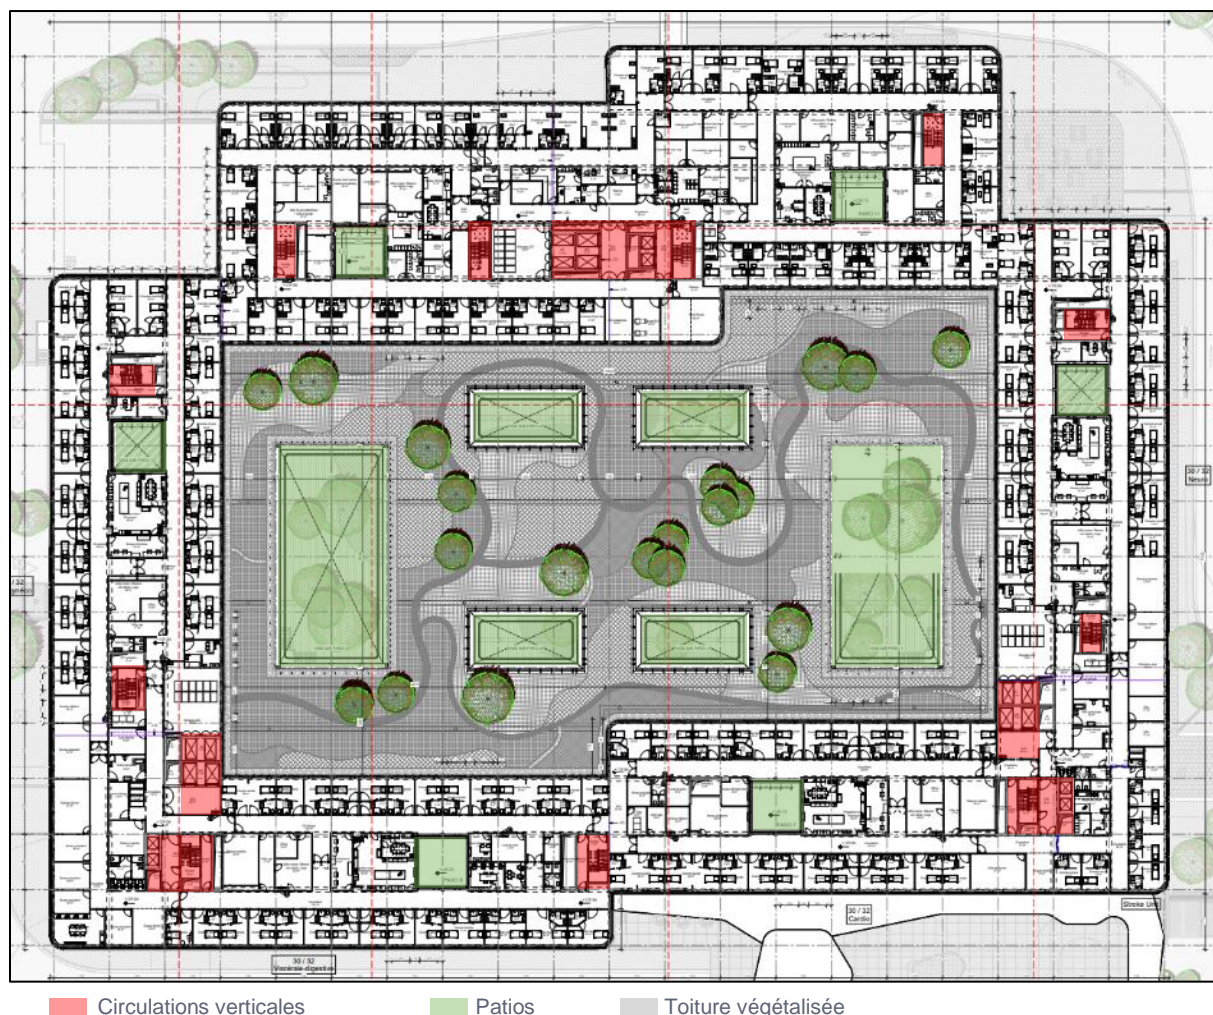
Plan du R+1 du bâtiment principal (source : assar architects)
